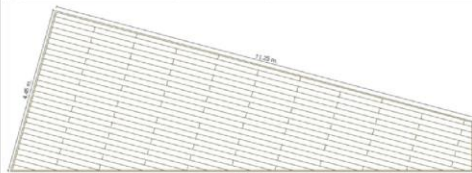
Plataforma tipo 2 deck Proyecto "Canal Gibbs"
